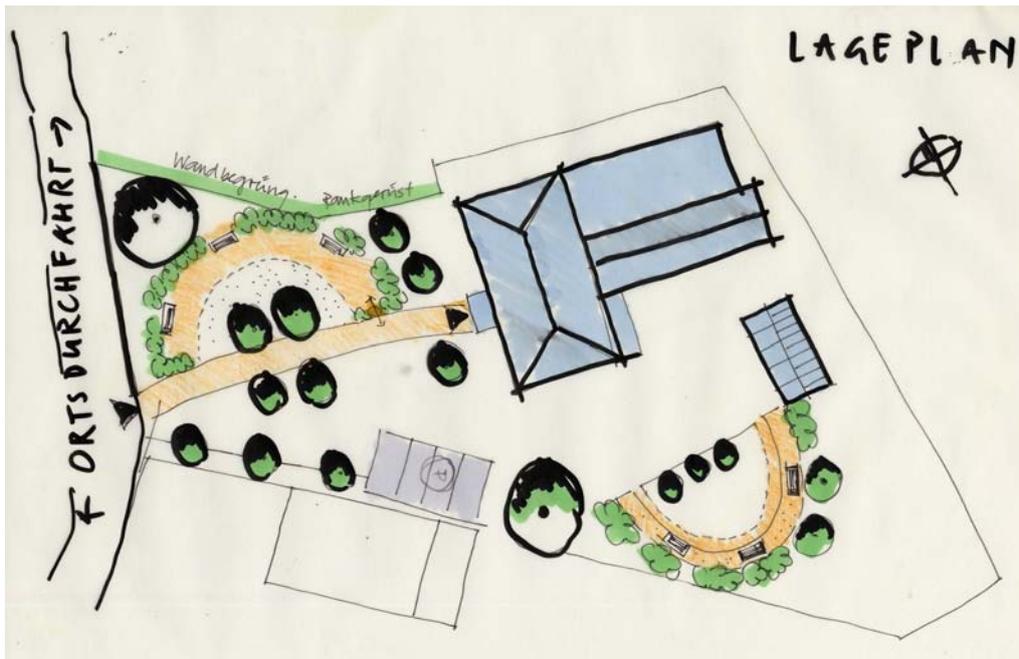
Oberheldungen Lageplan mit Freiraumplanung
